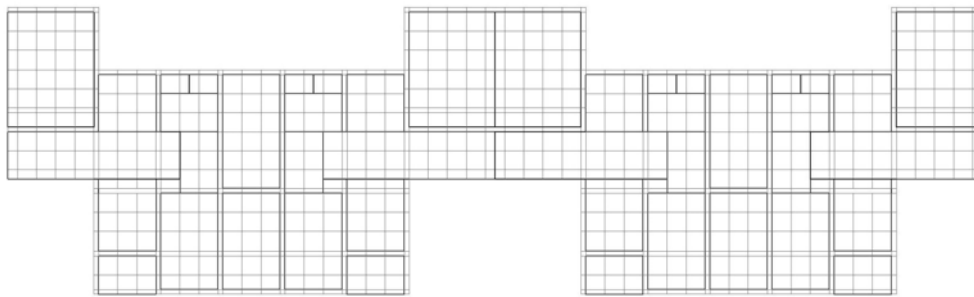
Trazado de la planta baja de las viviendas de profesores de la HfG. Como en su propuesta de torre de viviendas de 1950, se emplea una malla tartán en la que los muros principales que definen las crujeas se sitúan en una banda modular propia sin alterar la modulación de los espacios. (Autora)
